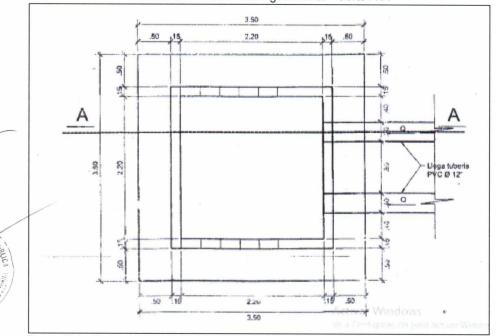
Plano P-04 denominado "Planta tuberías"
